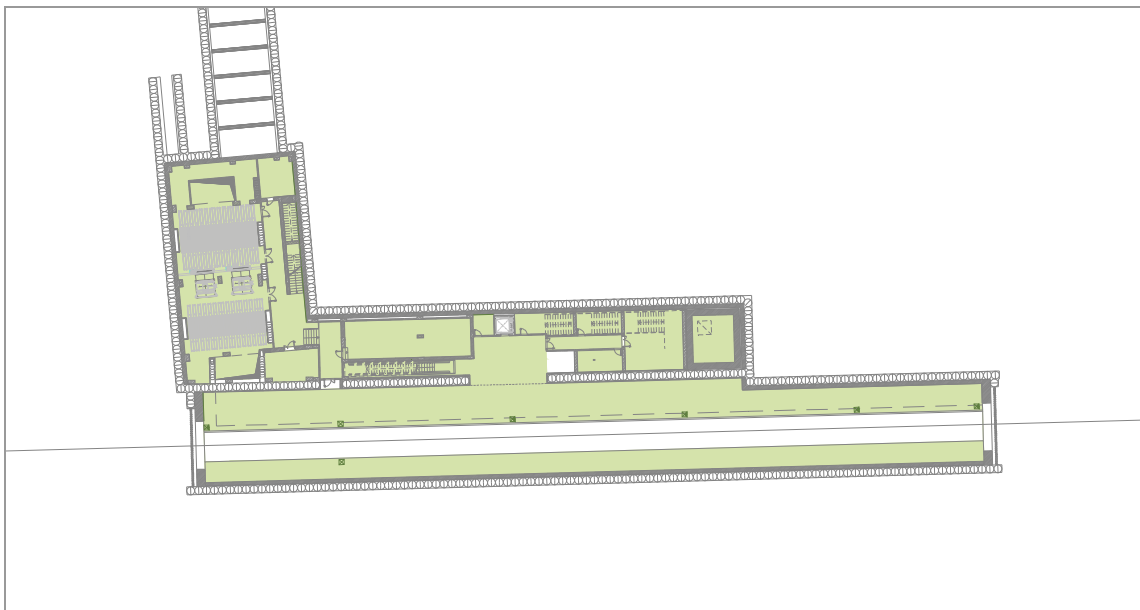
FASE 1 (Realizzazione opere interne: Strutture interne orizzontali e verticali)
